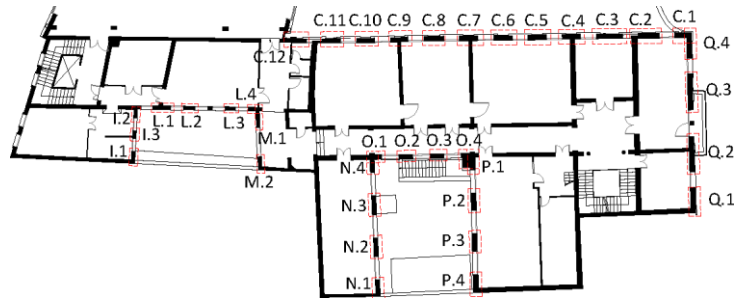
Pianta Primo Piano corpo D - Indicazione prospetti
